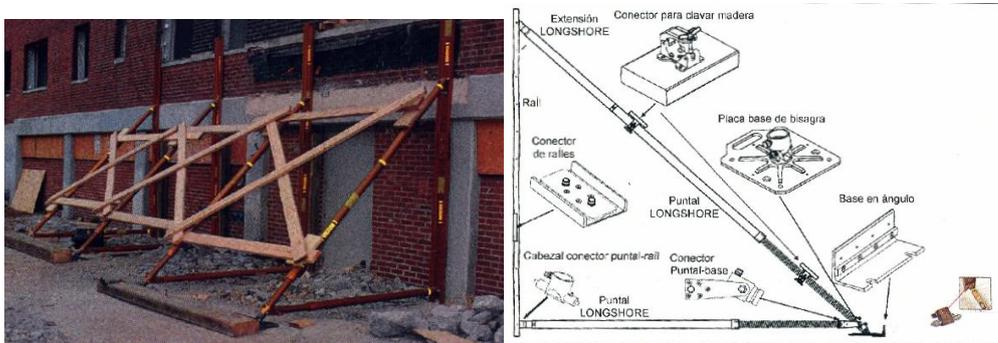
Kit de piezas para apuntalamiento de muro con puntal Longshore de PARATECH.
